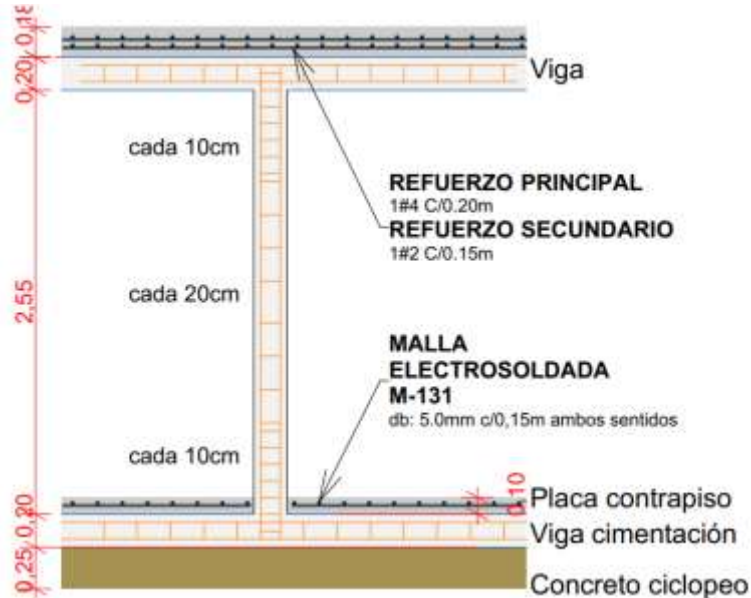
SECCION DE COLUMNA TIPO. Fuente: AutoCAD. Elaboración propia.
